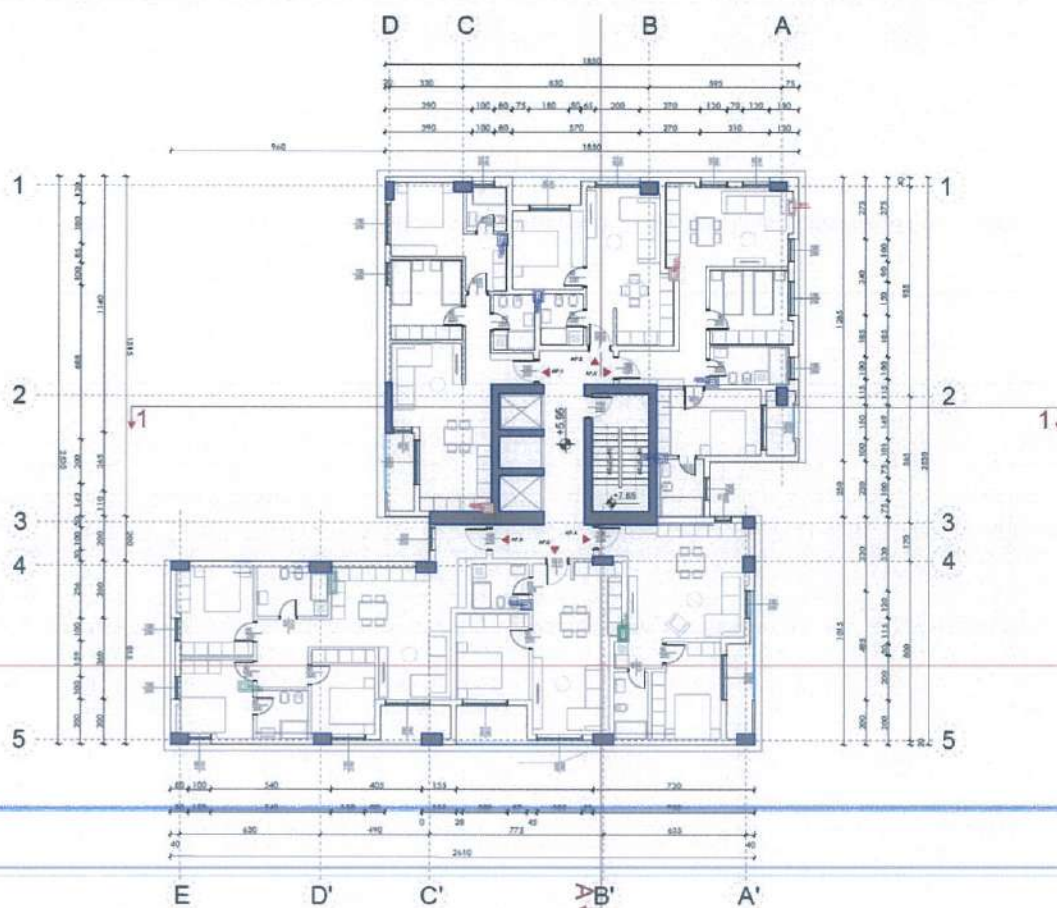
Planimetria e katit tip (+1,+2,+6,+10)
